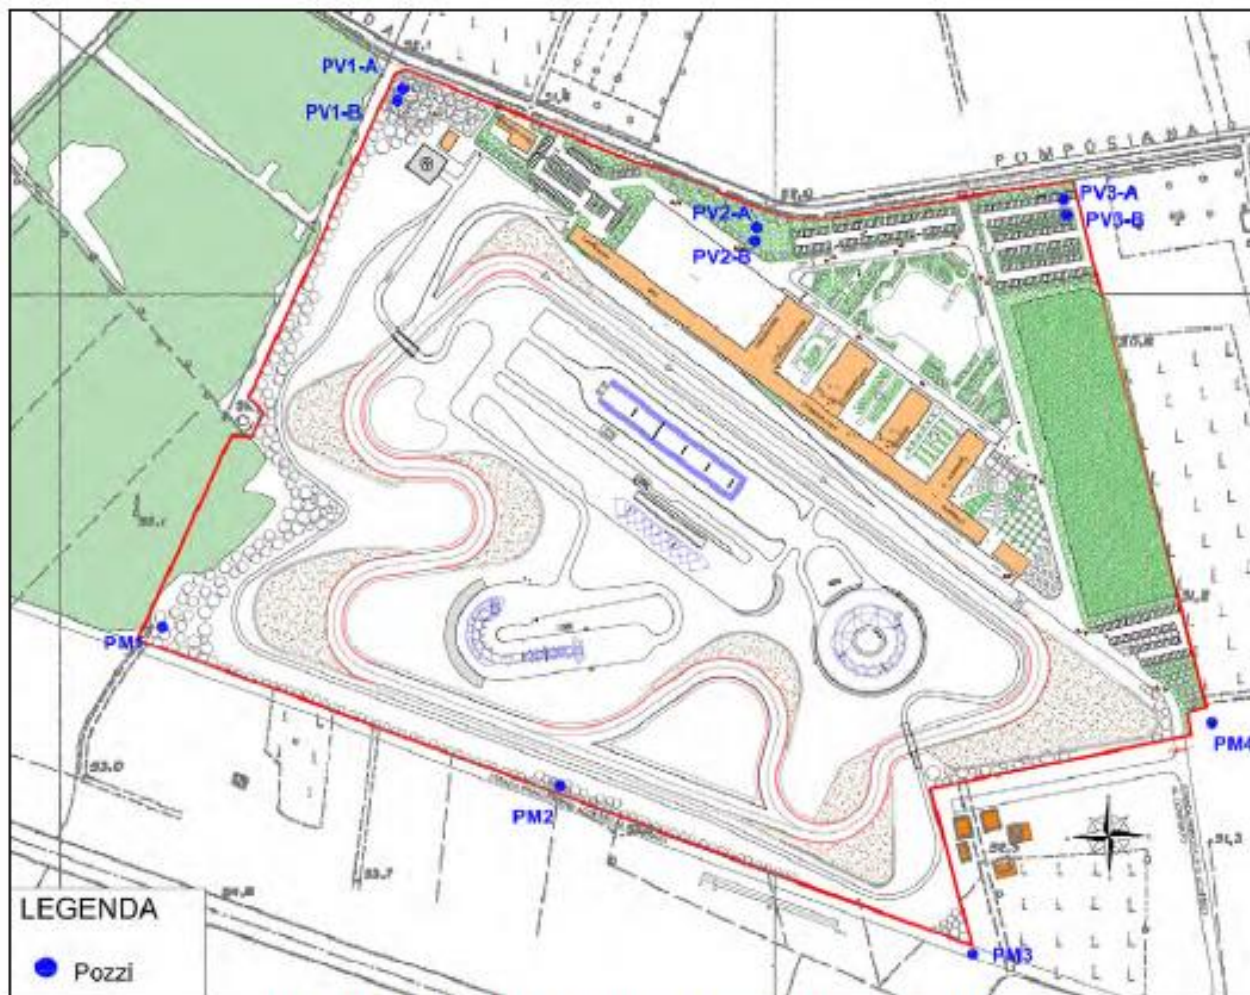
Ubicazione dei pozzi e dei piezometri di monitoraggio.
